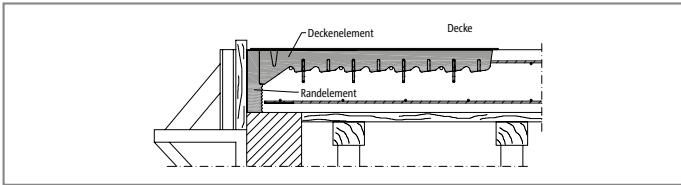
IDock1: Außenwand als direktes Auflager (kein Randunterzug); die Deckenaussparung wird durch die beiden Komponenten Randelement und Deckenelement abgeschalt.
